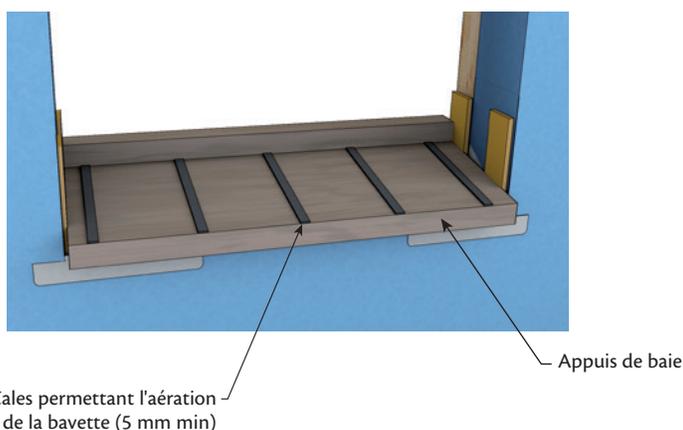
Exemple de calage sur l'appui de baie et ventilation de la bavette
